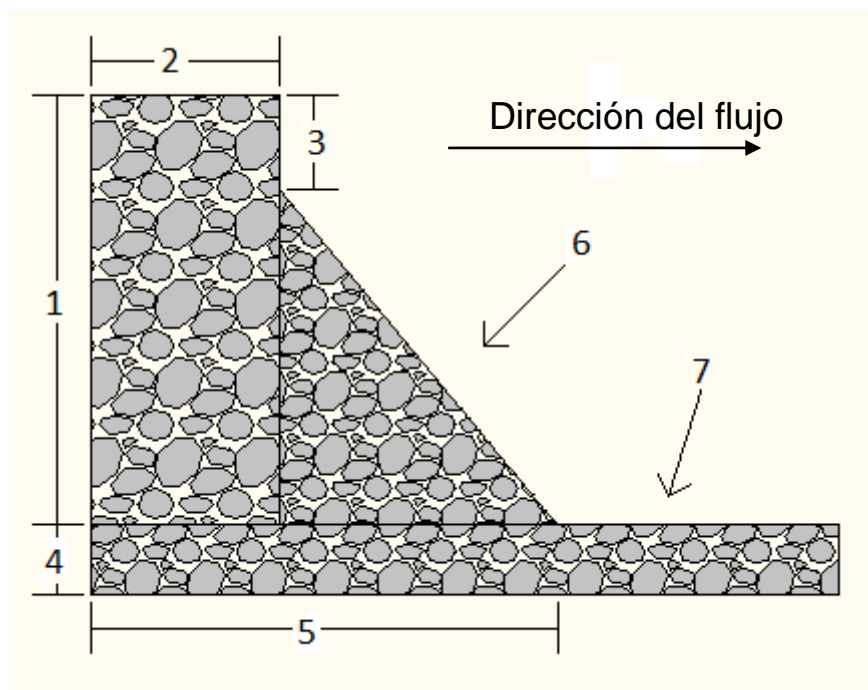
Sección transversal de una presa de piedra. *Fuente: Elaboración propia.
